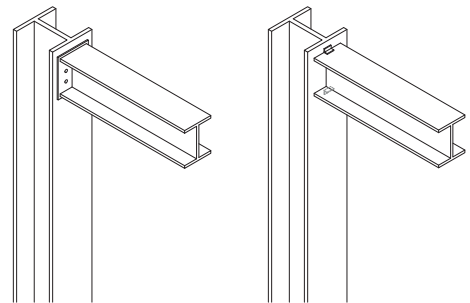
Axonometrías constructivas de ejemplos de uniones entre viga-pilar de acero.
